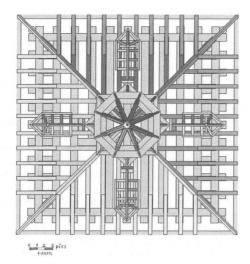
Planta de la armadura del chapitel con los pináculos (Dibujo del autor)
